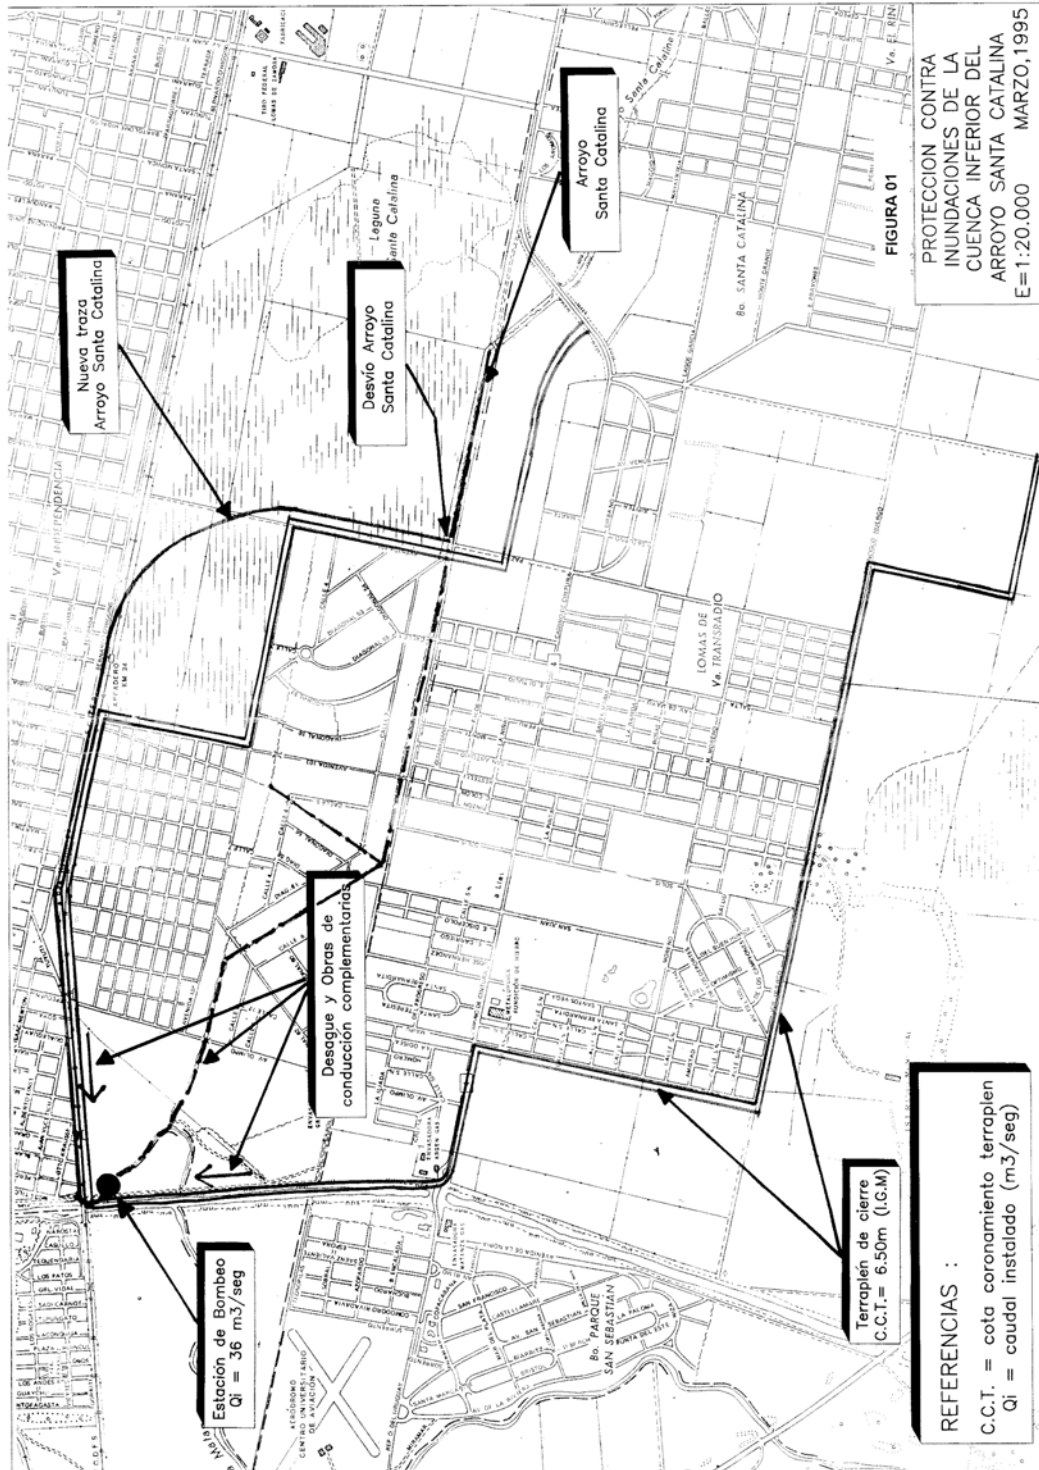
Protección contra inundaciones de la cuenca inferior del arroyo Santa Catalina prevista en el Plan de 1994.
